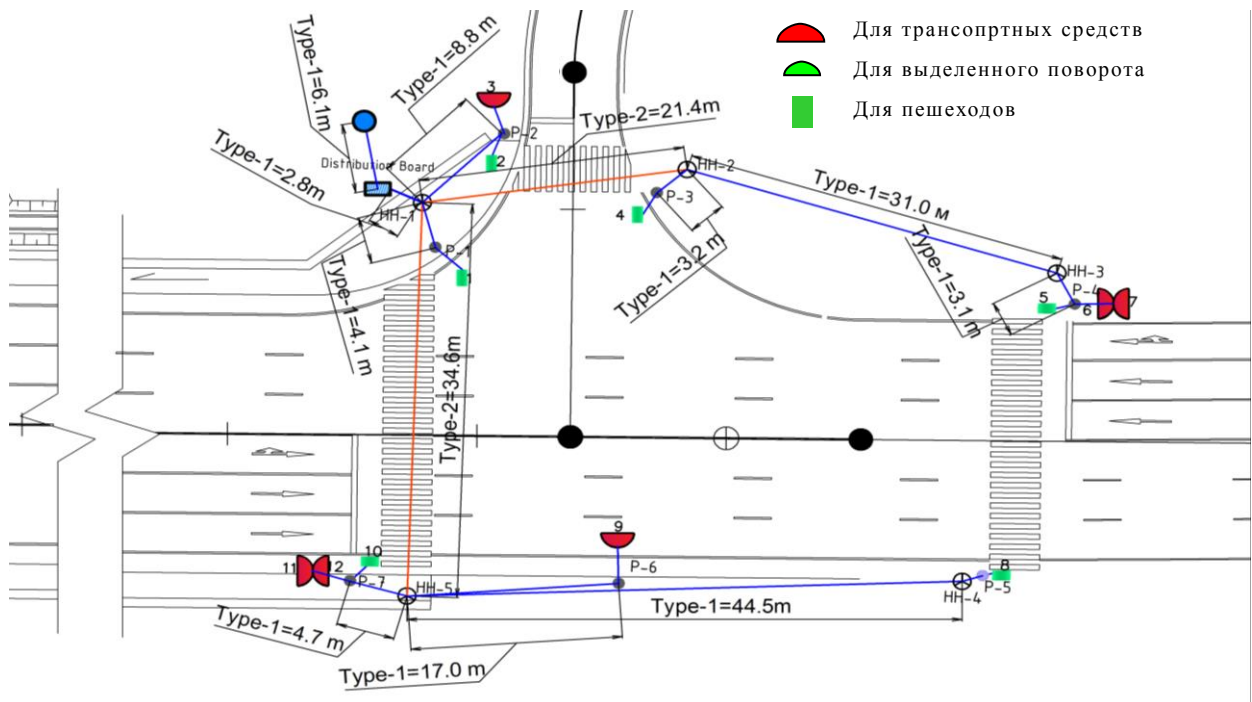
Перекресток-02 (ПК 820) [2/2]
